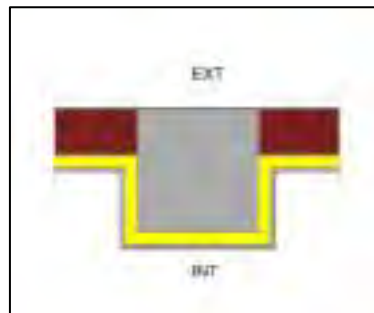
Solución constructiva puente térmico pilar. DBHE.
